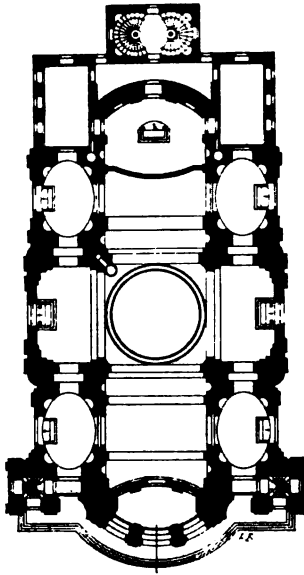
Grundriss der Kollegienkirche zu Salzburg
